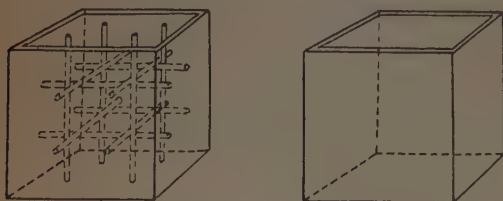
Essai FAURY. Moules avec et sans ferrailage (d'après FAURY).
